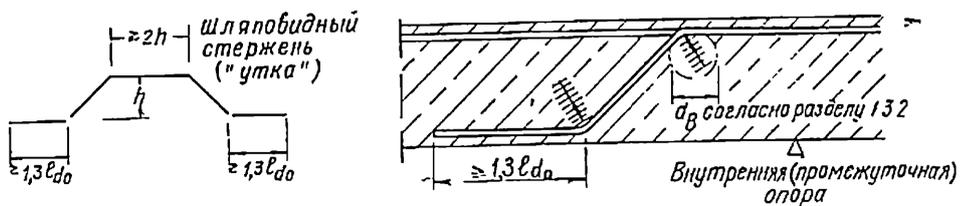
8. Заделка отогнутых (а) и загнутых (б) стержней, служащих для восприятия усилий на скалывание
